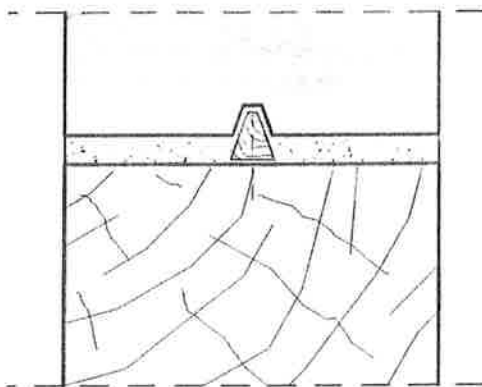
Ausführungsbeispiel zur Fuge Gefach/Holz; hier: Verankerung mit Holzleiste
